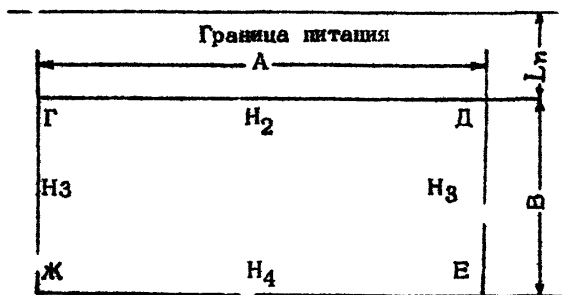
Схема к расчету водопритока к огничной выработке.
